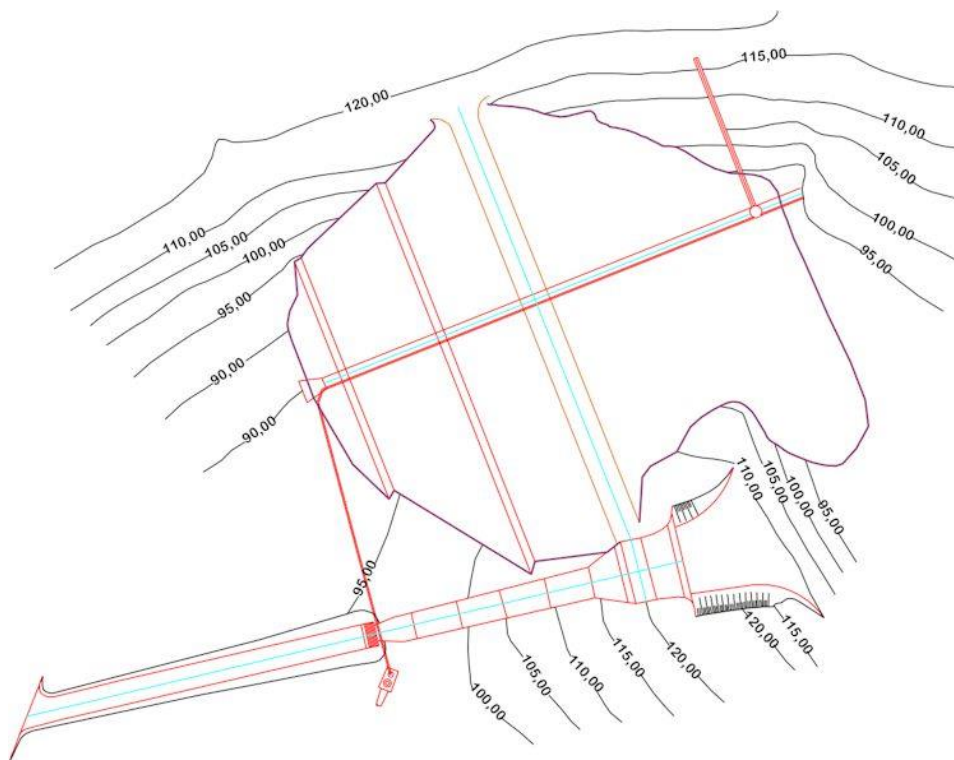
Planta da barragem (Fonte: <https://cnpqb.apambiente.pt/content/a%C3%A7afal>).
